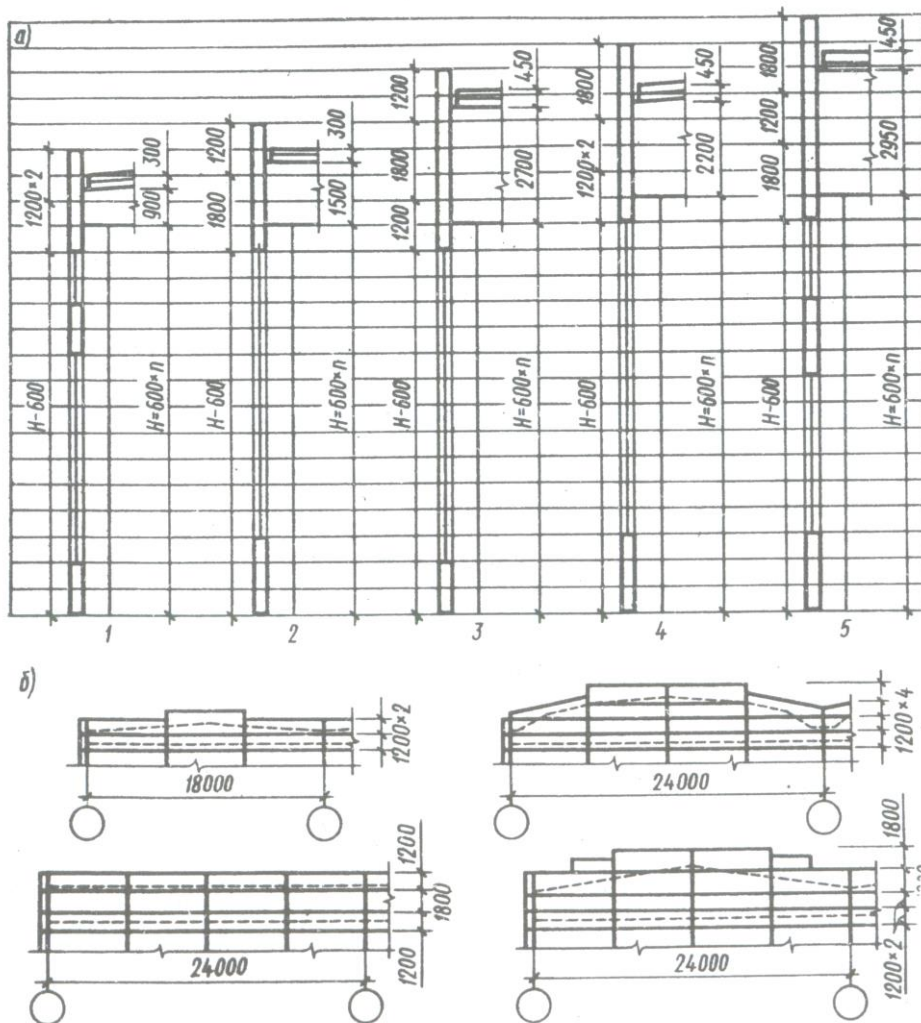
Варианты раскладки панелей стен одноэтажных зданий:
